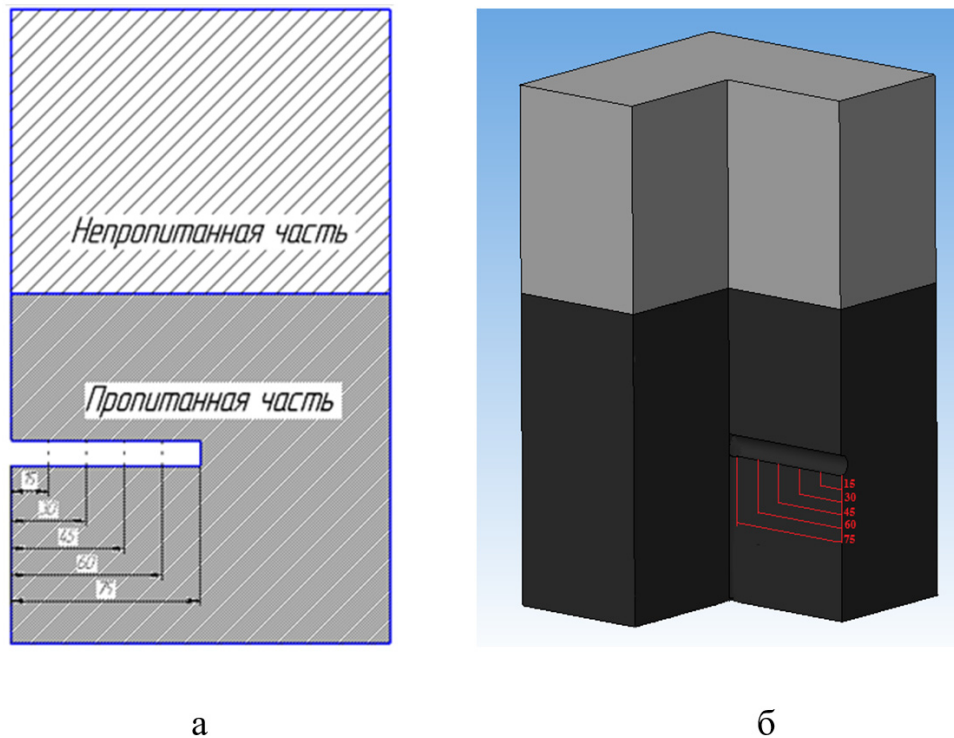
Схема сверления пропитанного блока размером 150·150·250 мм, а — схема сверления; б — 3-D модель сверления
